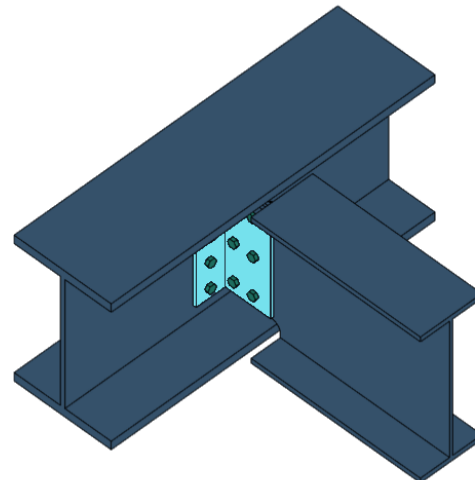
Articulation poutre-solive par cornières boulonnés sur l'âme de la poutre - perspective
